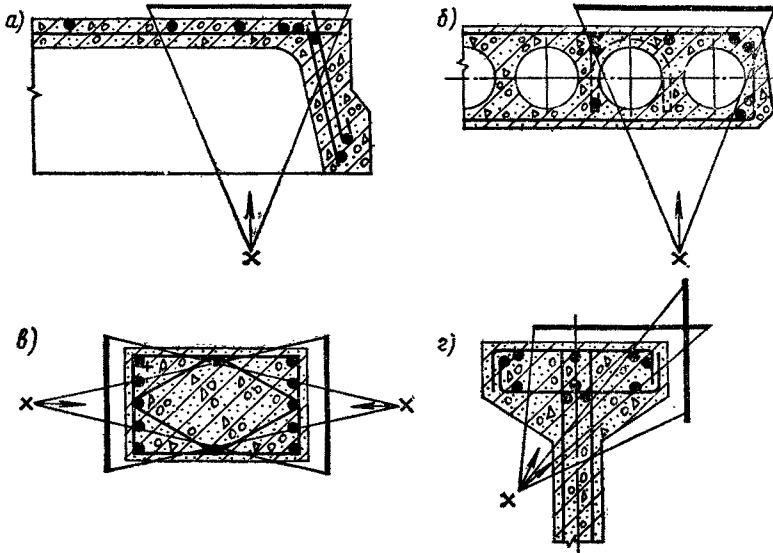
Примерные схемы просвечивания железобетонных конструкций
